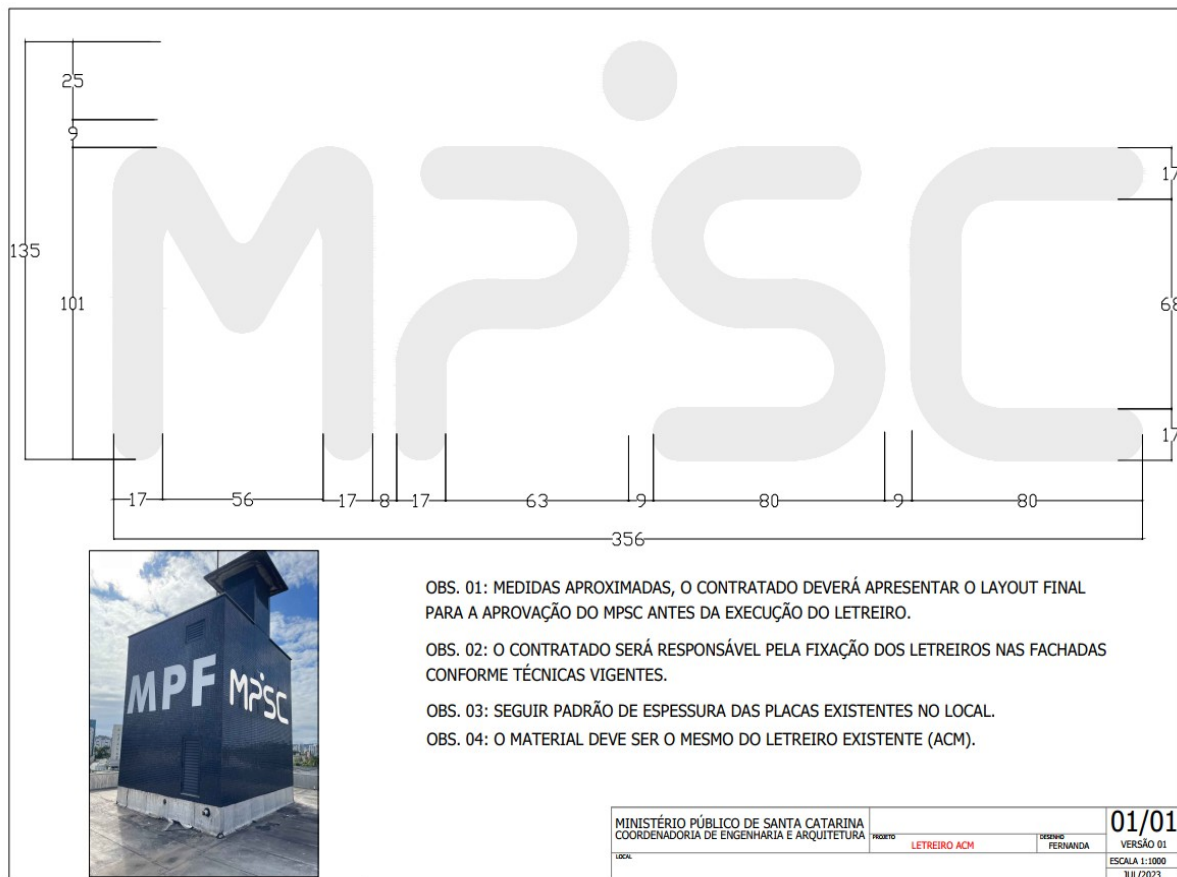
e 3 – Projeto/modelo para instalação de letras caixa em inox na fachada da edificação:
